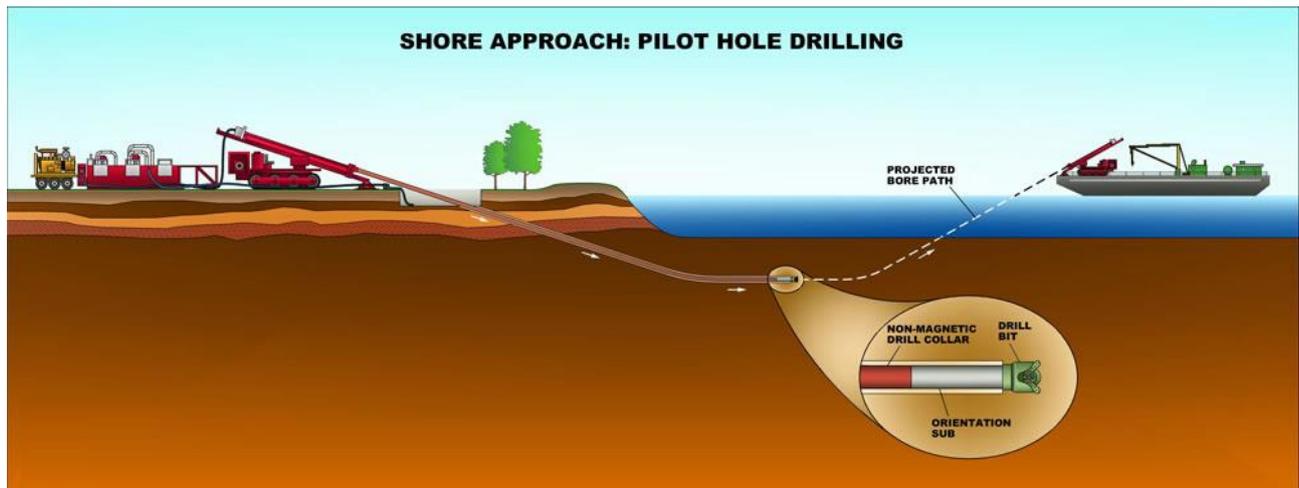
Schema posizionamento cavo con trivellazione Orizzontale Controllata
